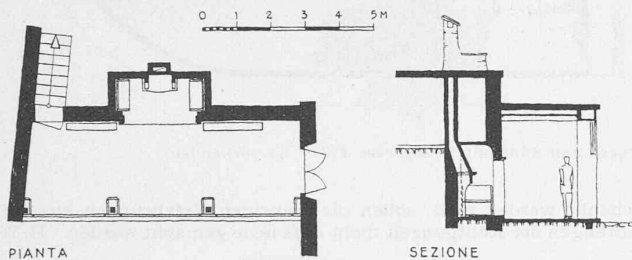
Grundriss und Schnitt des Loggia-Umbaus in Massagno. 1:200
